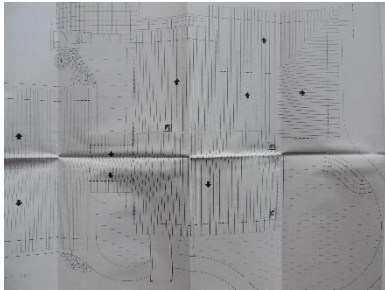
Extracto del plano de cubierta. Fuente propia. 2018
